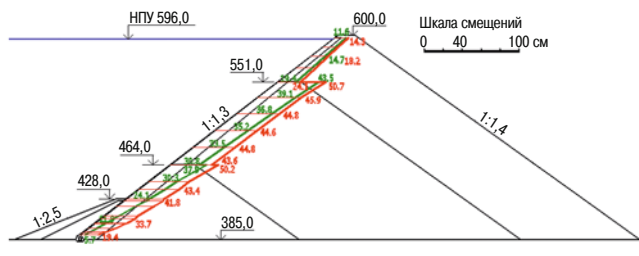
Смещения железобетонного экрана, см, для вариантов 1 и 2:
